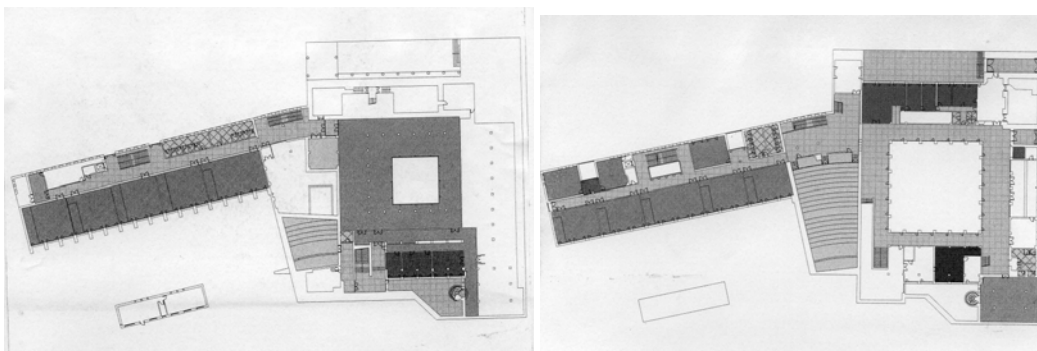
y 311. Facultad de Geografía e Historia: planimetría de la torre y fachadas a las calles Cervantes y Rabanal.
